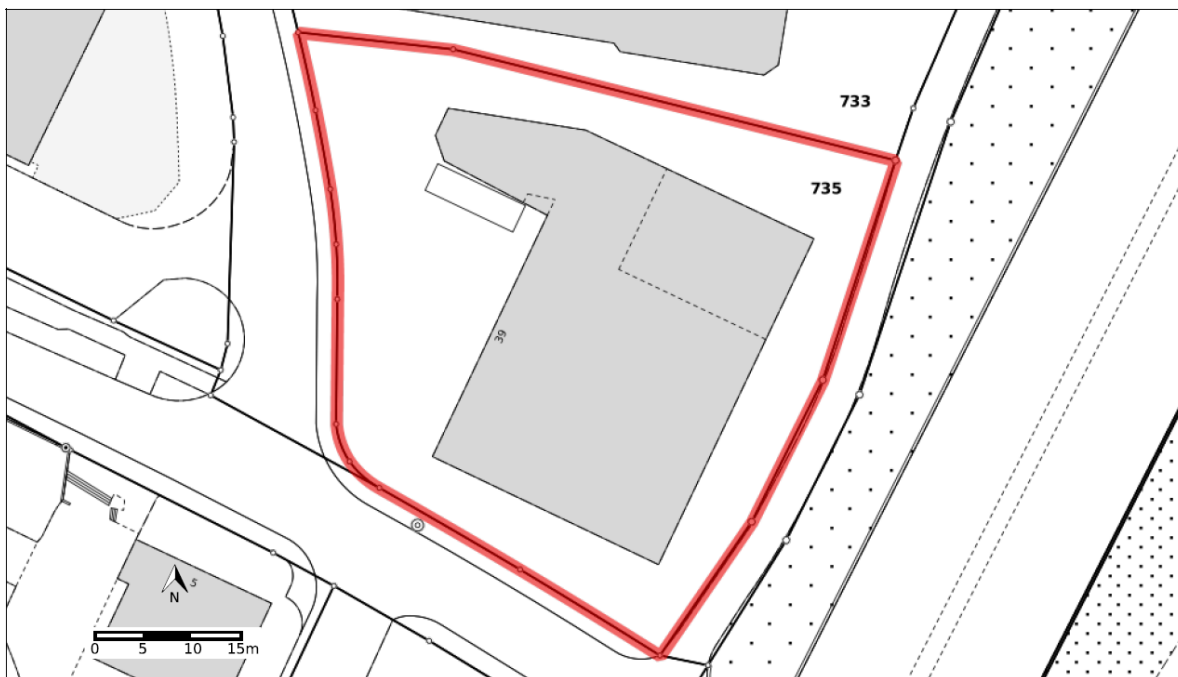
Exemple d'un extrait de plan sur la page de couverture
